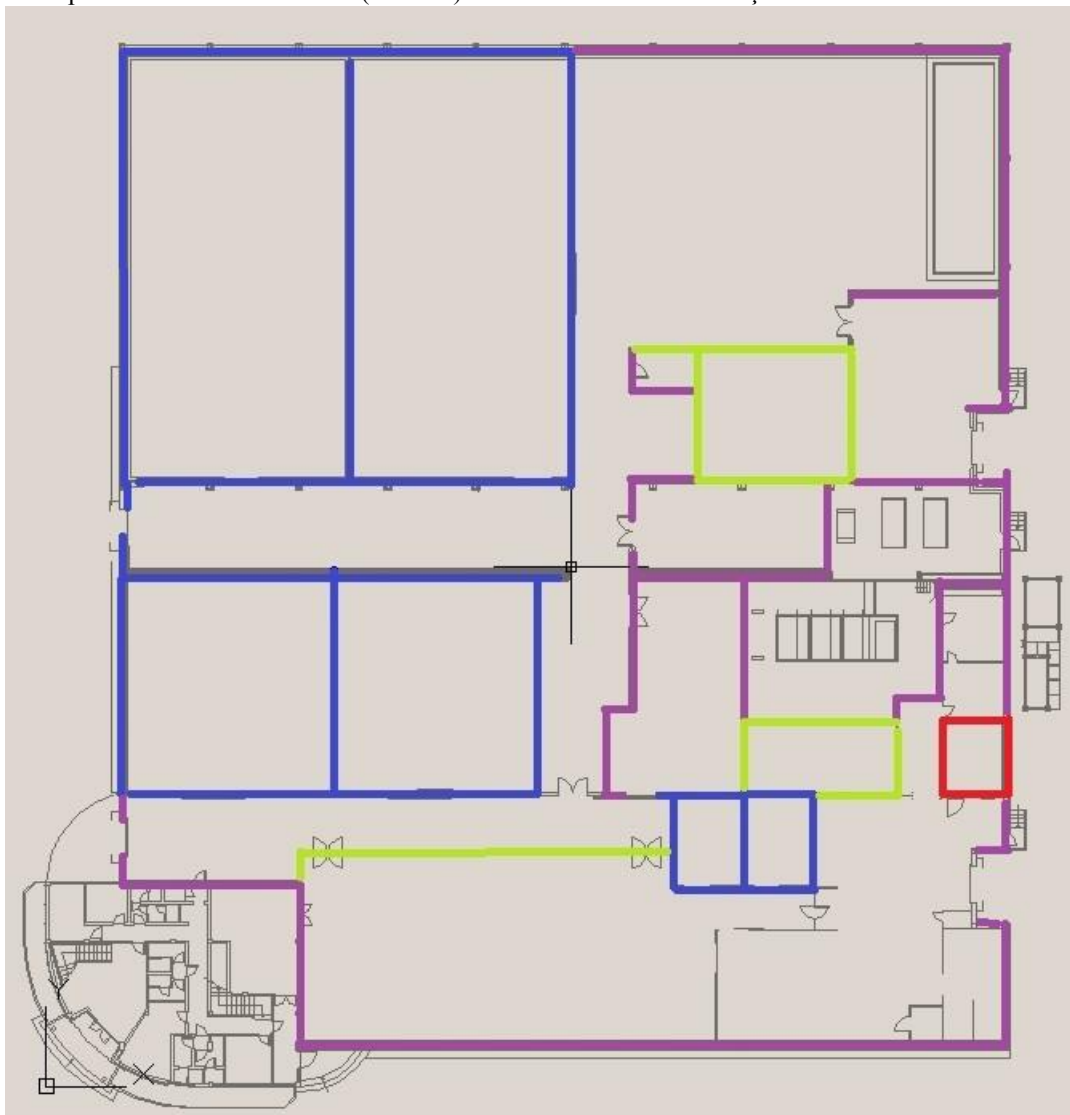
Disposição das Soluções Construtivas Exteriores
